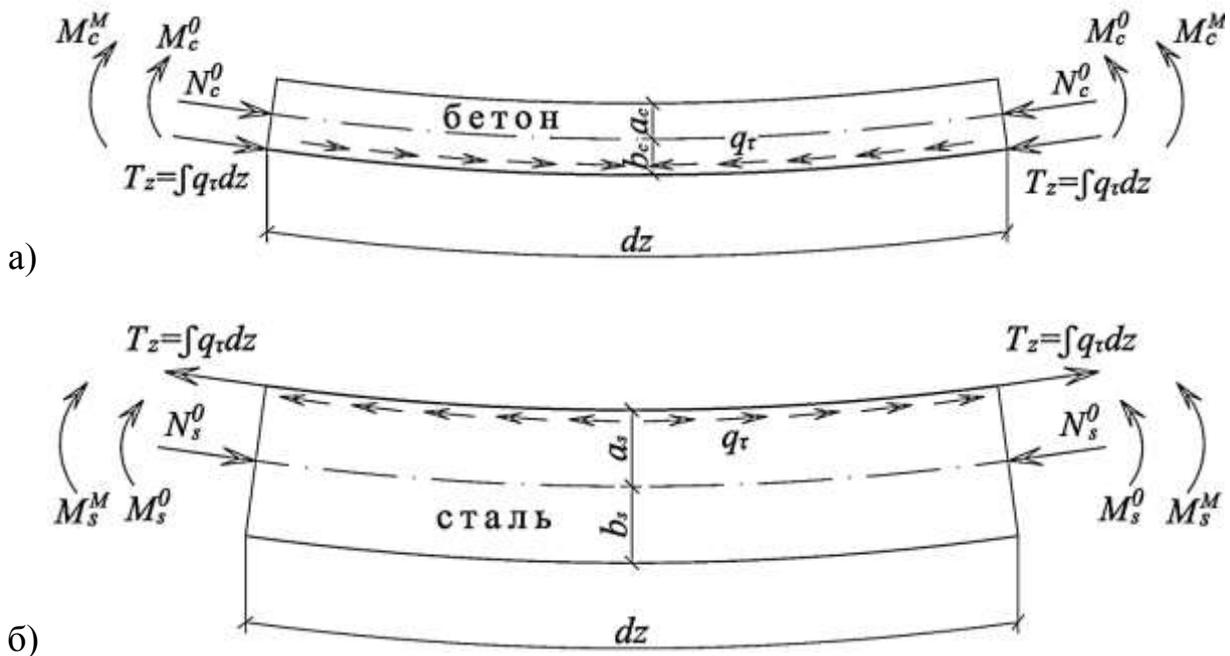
Верхній залізобетонний (а) та нижній сталевий (б) шари сталезалізобетонної балки, із заміною внутрішніми зусиллями відкинутих лівої та правої частин балки, а також нижнього чи верхнього шару
